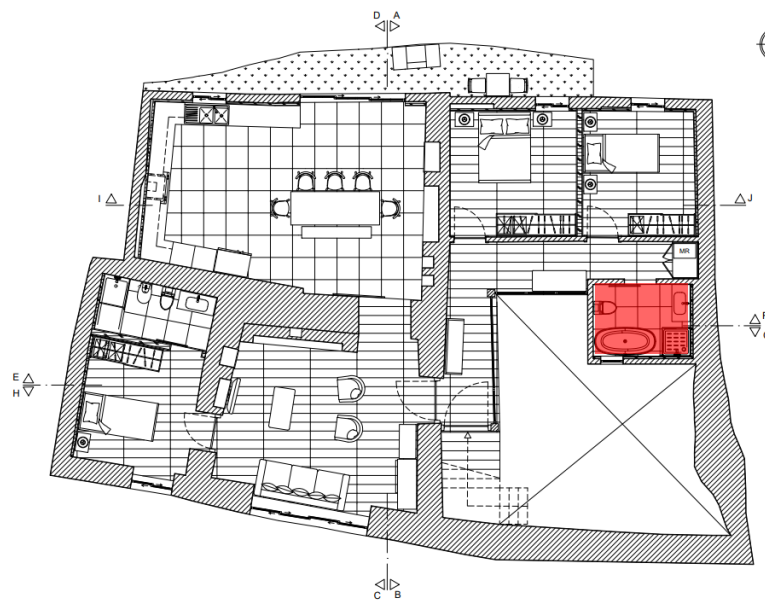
Planta de apresentação zona da casa de banho. Fonte: Daniela Alves
